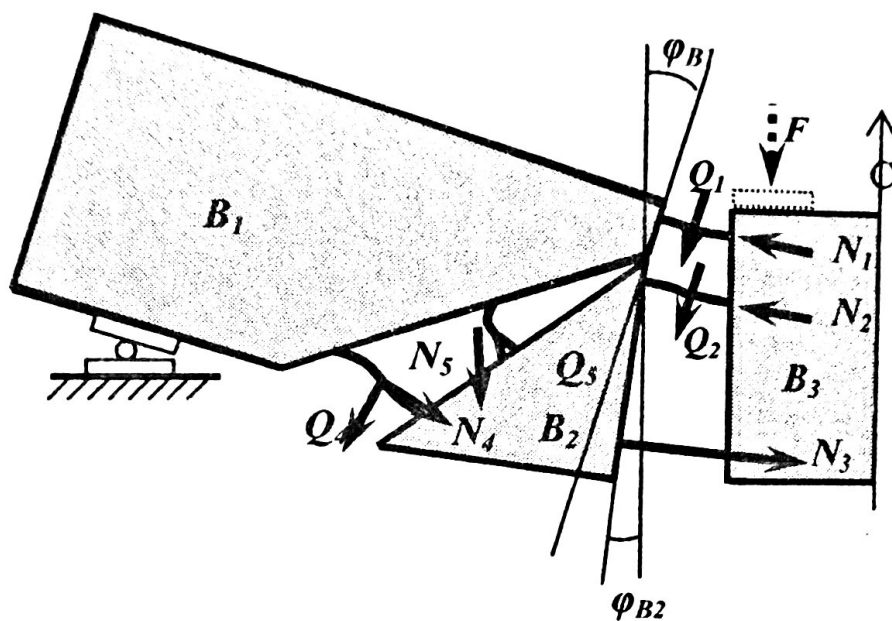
Физическая модель и кинематическая схема деформирования при опорном участке изгибаемого железобетонного элемента по А.С. Залесову и Ю.А. Климову [7].
